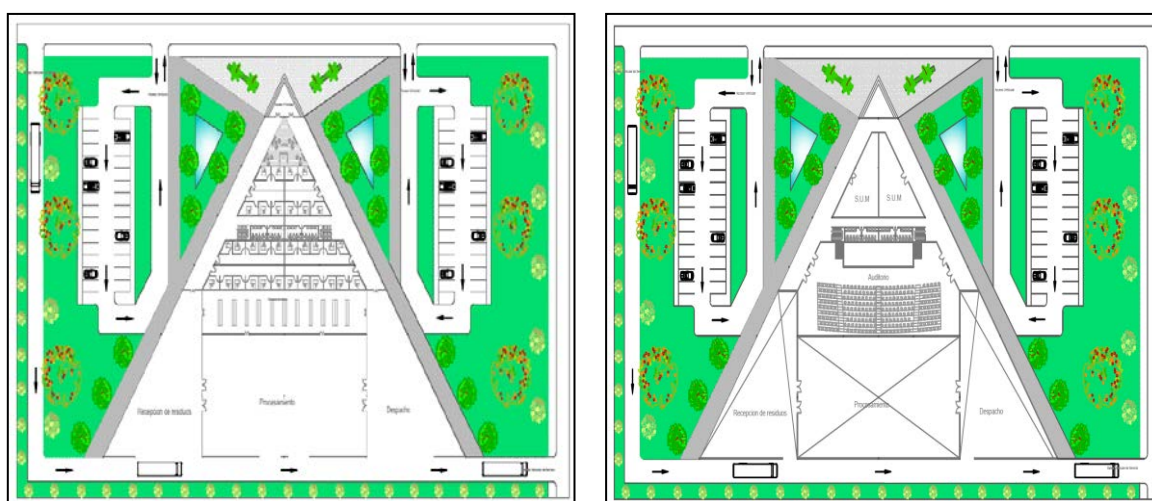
Distribución del Centro Reciclaje- Planta Baja y Planta Alta
